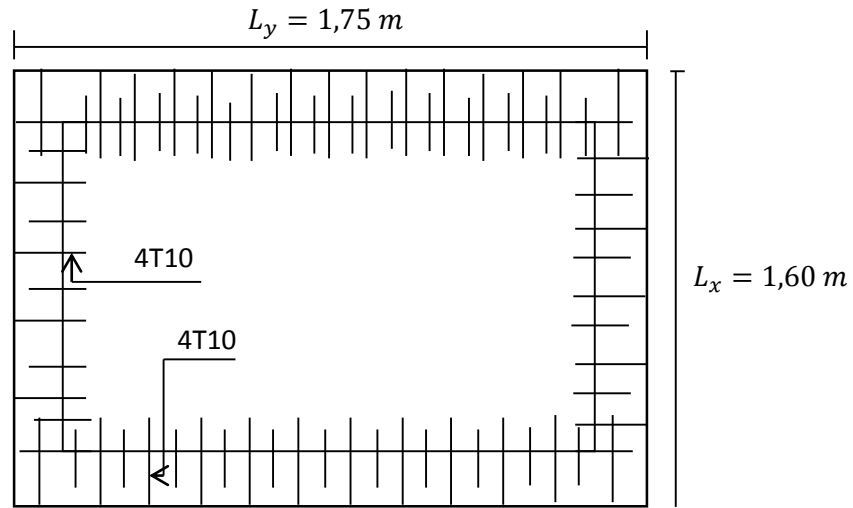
Ferrailage supérieur de la dalle de l'ascenseur.
